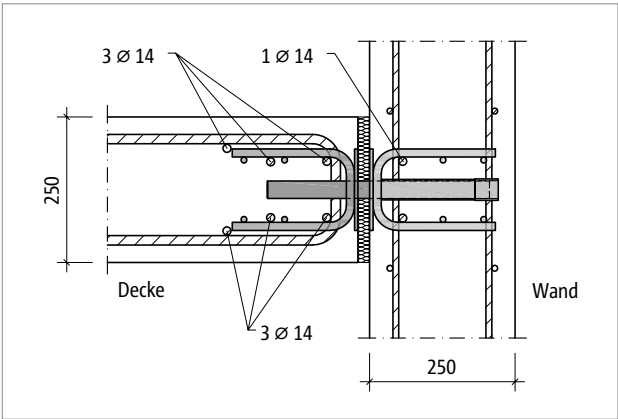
Schnitt durch Anschluss Decke-Wand mit Bewehrungsanordnung
